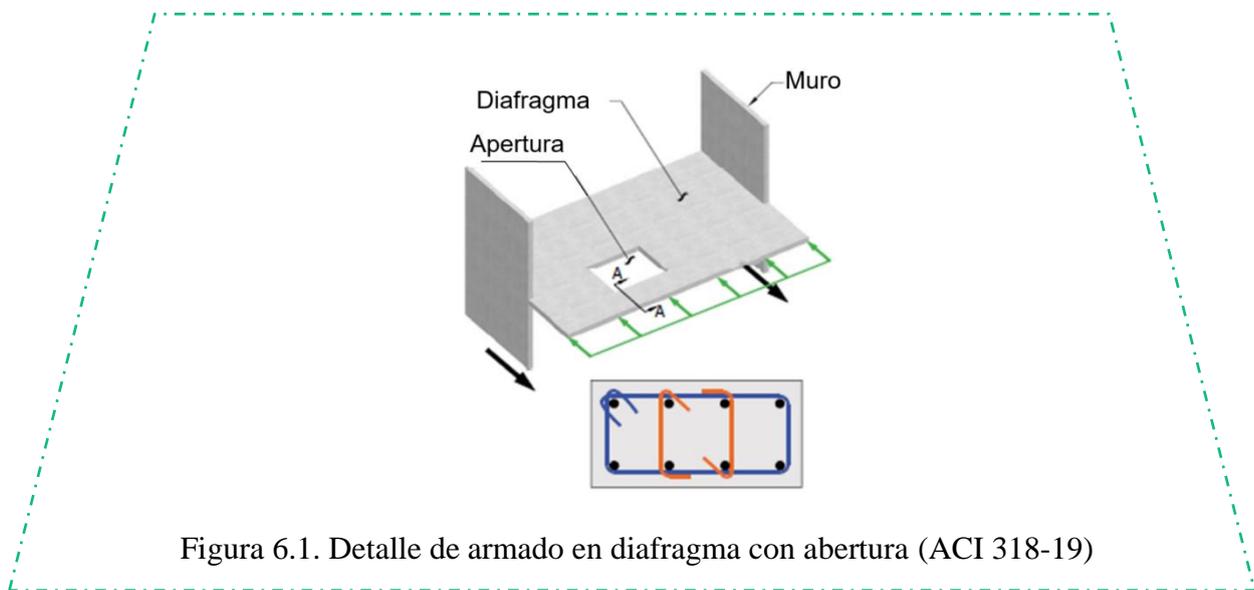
Detalle de armado en diafragma con apertura (ACI 318-19)
